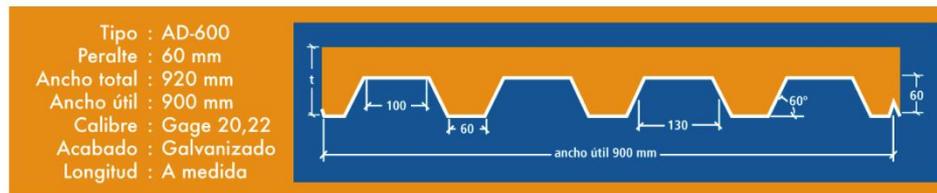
SISTEMA DE LOSA COLABORANTE PARA ESTRUCTURAS METALICAS
